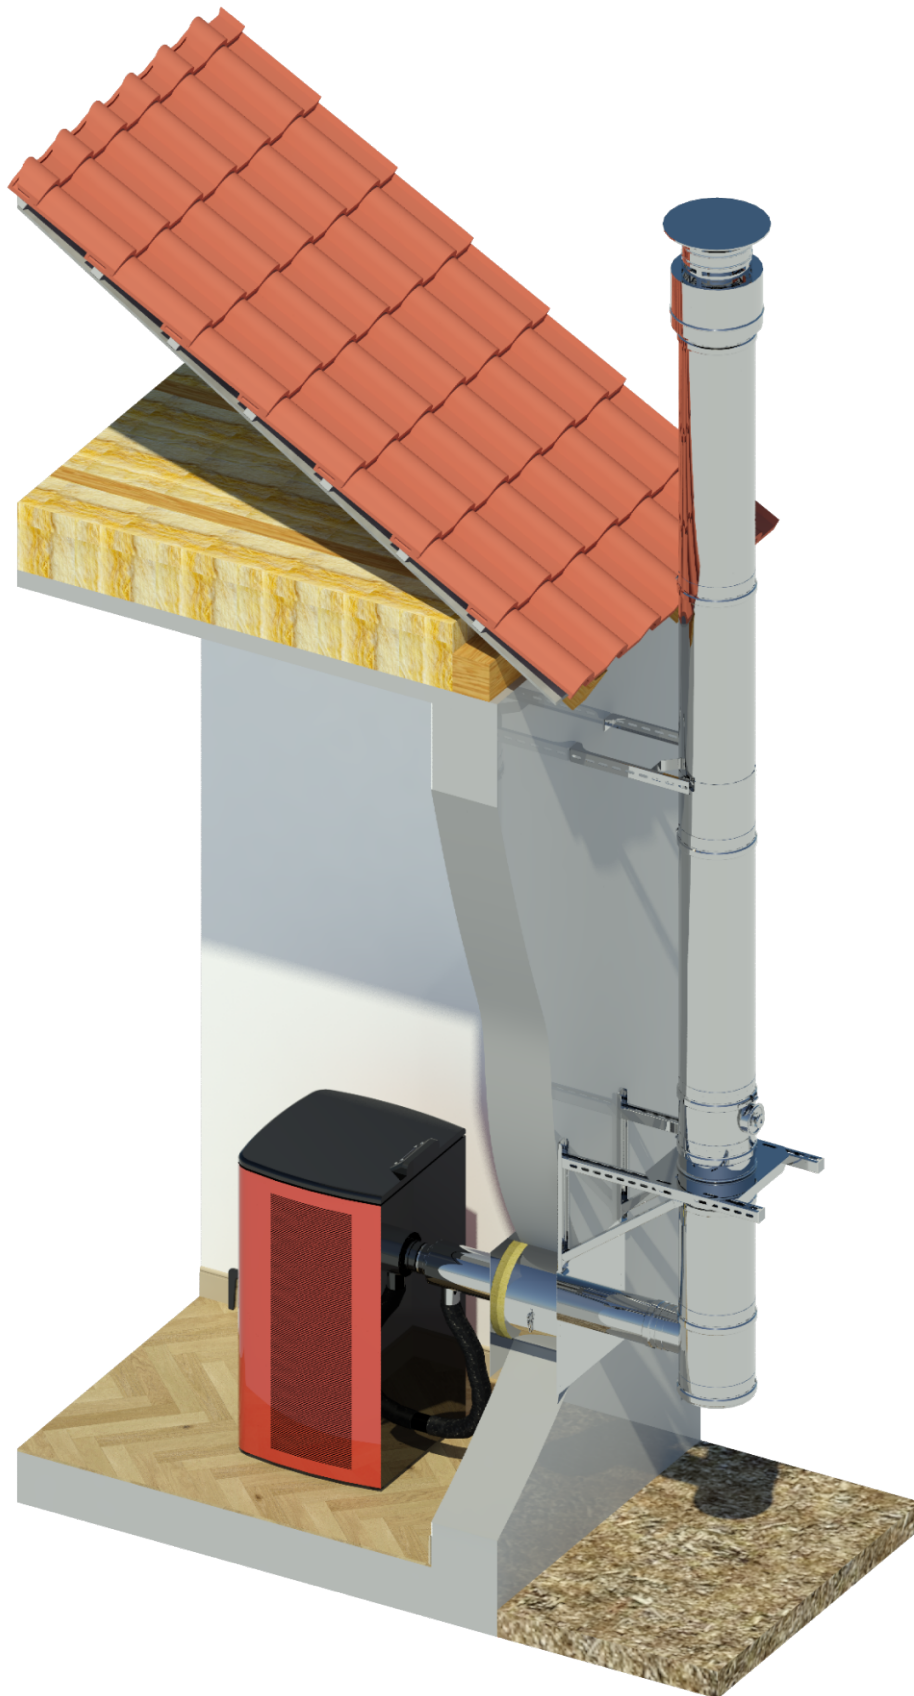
Situation de traversée de paroi verticale (sortie murale)
